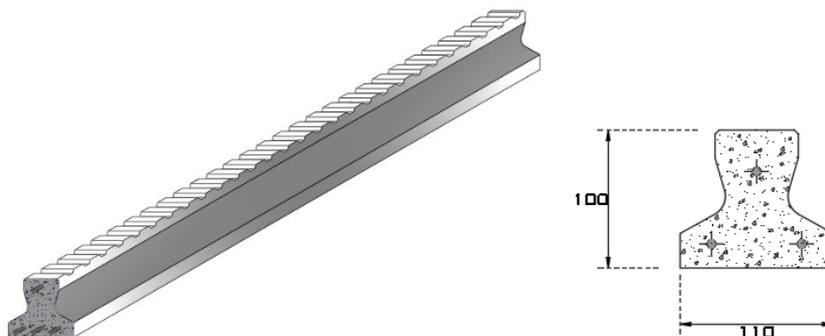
Detalle de vigueta pretensada vista Frontal y 3D
